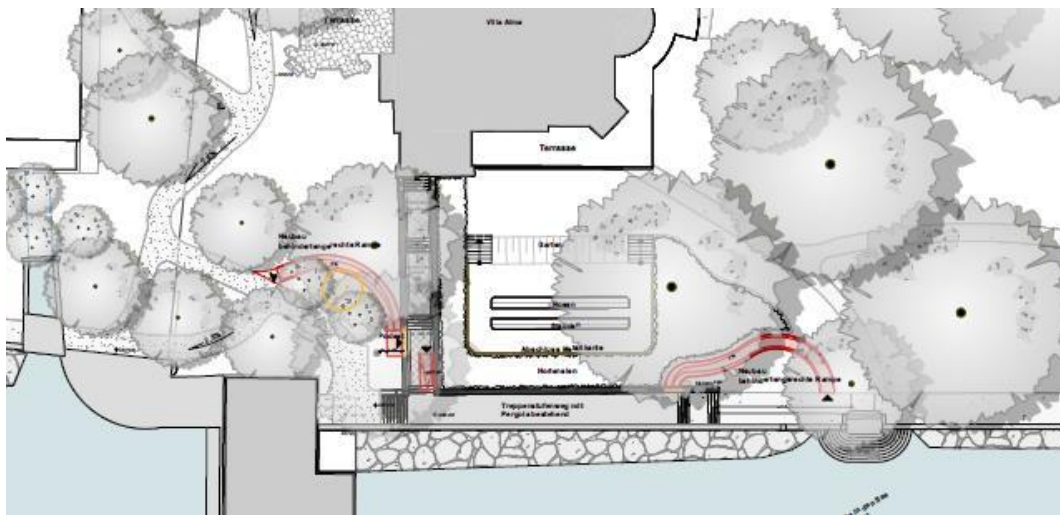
Planausschnitt Variante 1 – Wegführung mit Rampen
